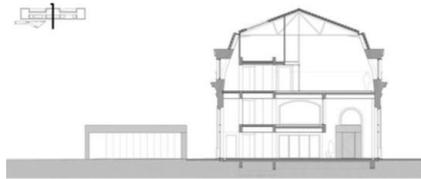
Corte transversal da Estação de Burgos. Detalhe para nova divisão de pavimentos independente da arquitetura preexistente. Fonte: Acervo site Archdaily. Acesso em Junho/2018
